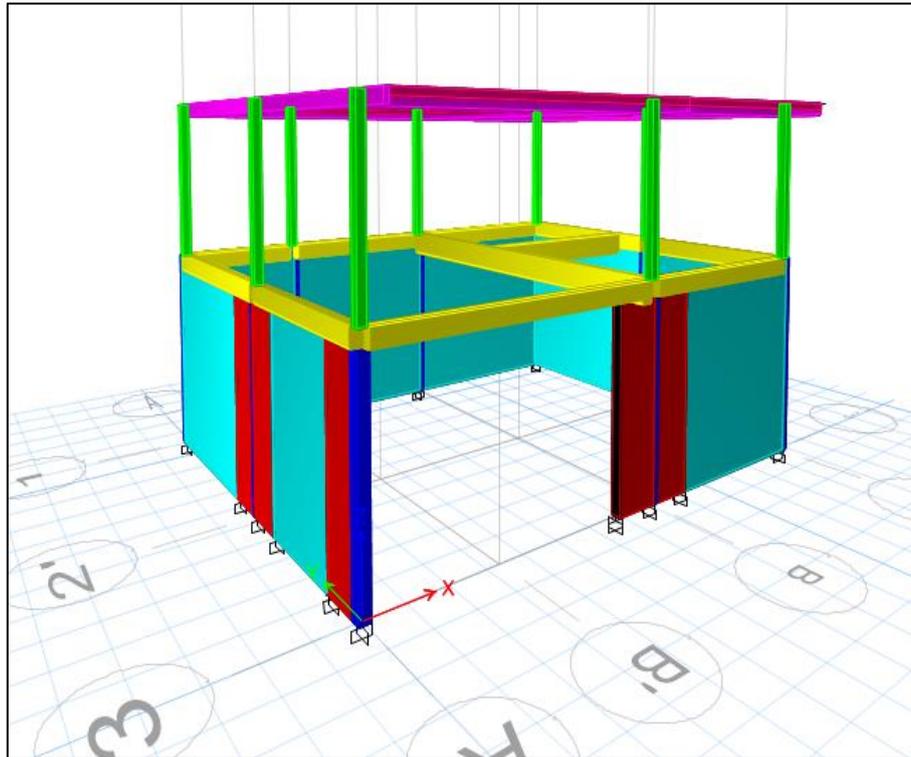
Modelado con el reforzamiento mediante adición de muros laterales
